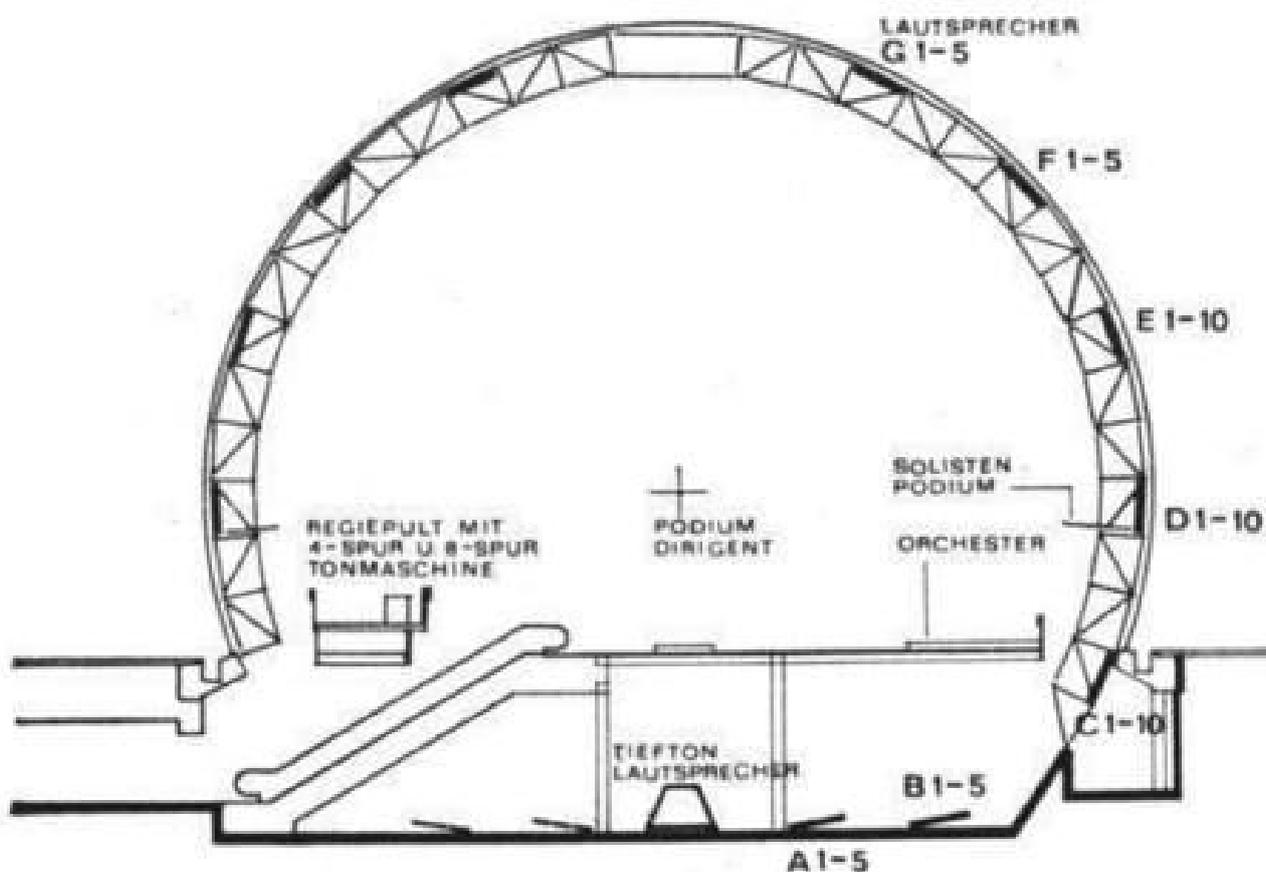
Plan de coupe du dôme de l'exposition universelle (K. STOCKHAUSEN et BLUMRÖDER 1978)
